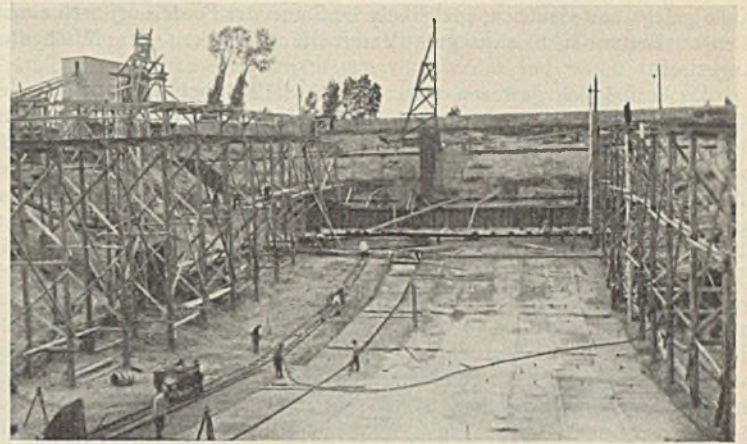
Baugrube nach dem Erreichen der Sohle.
